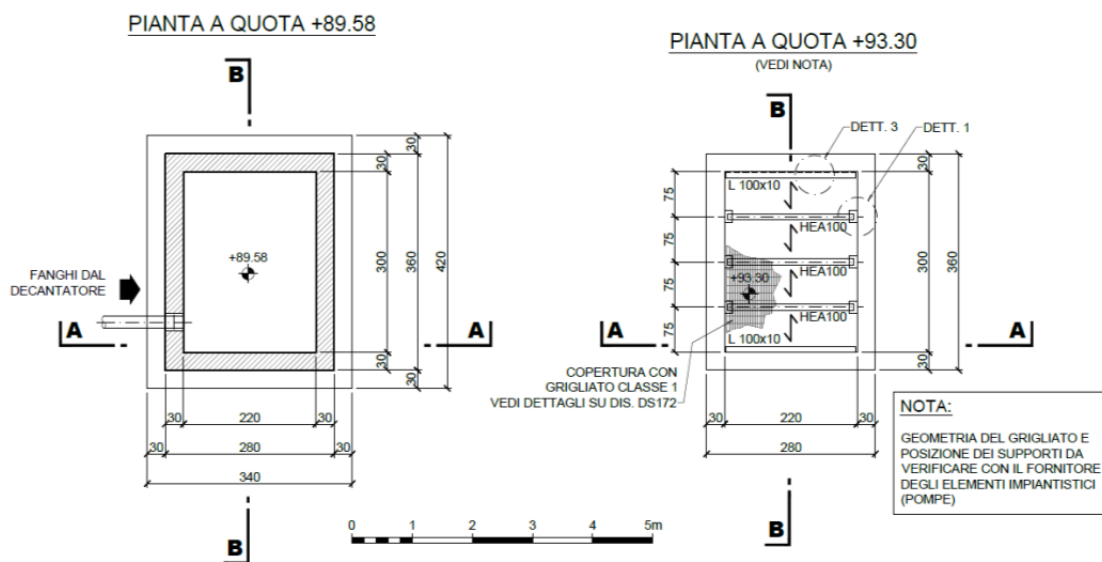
POZZETTO FANGHI – PIANTA
